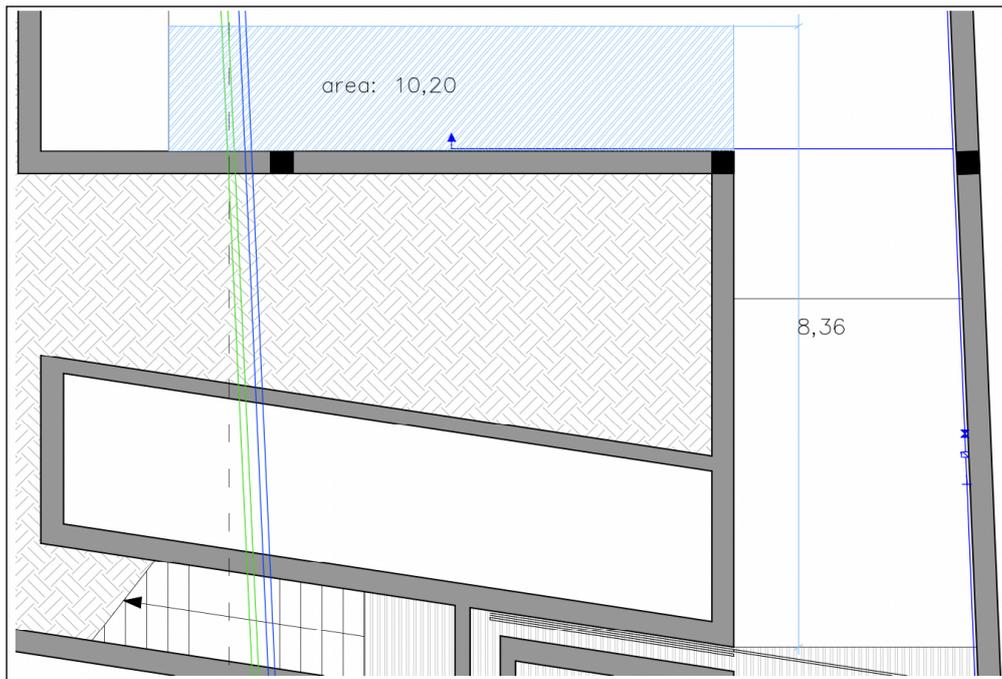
Planta sótano con medición de área mínima y distancia al acceso.
